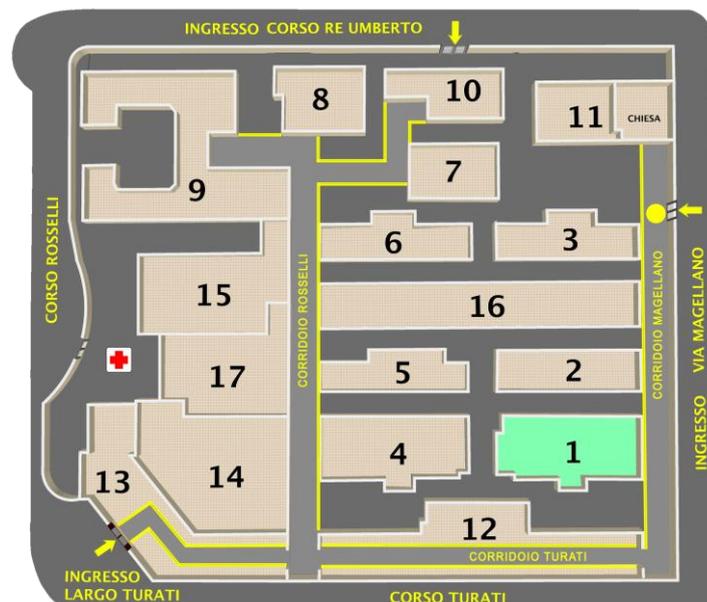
Planimetria generale Ospedale Mauriziano (caso studio)
